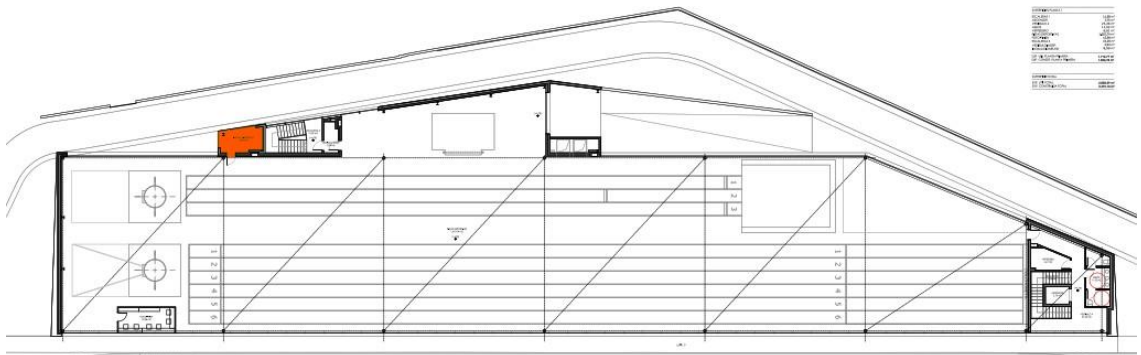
Ubicación sala técnica con unidades exteriores de la planta primera.
